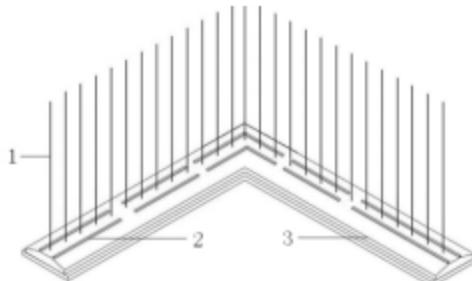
空腔聚苯模块混凝土墙体限位卡槽安装示意
